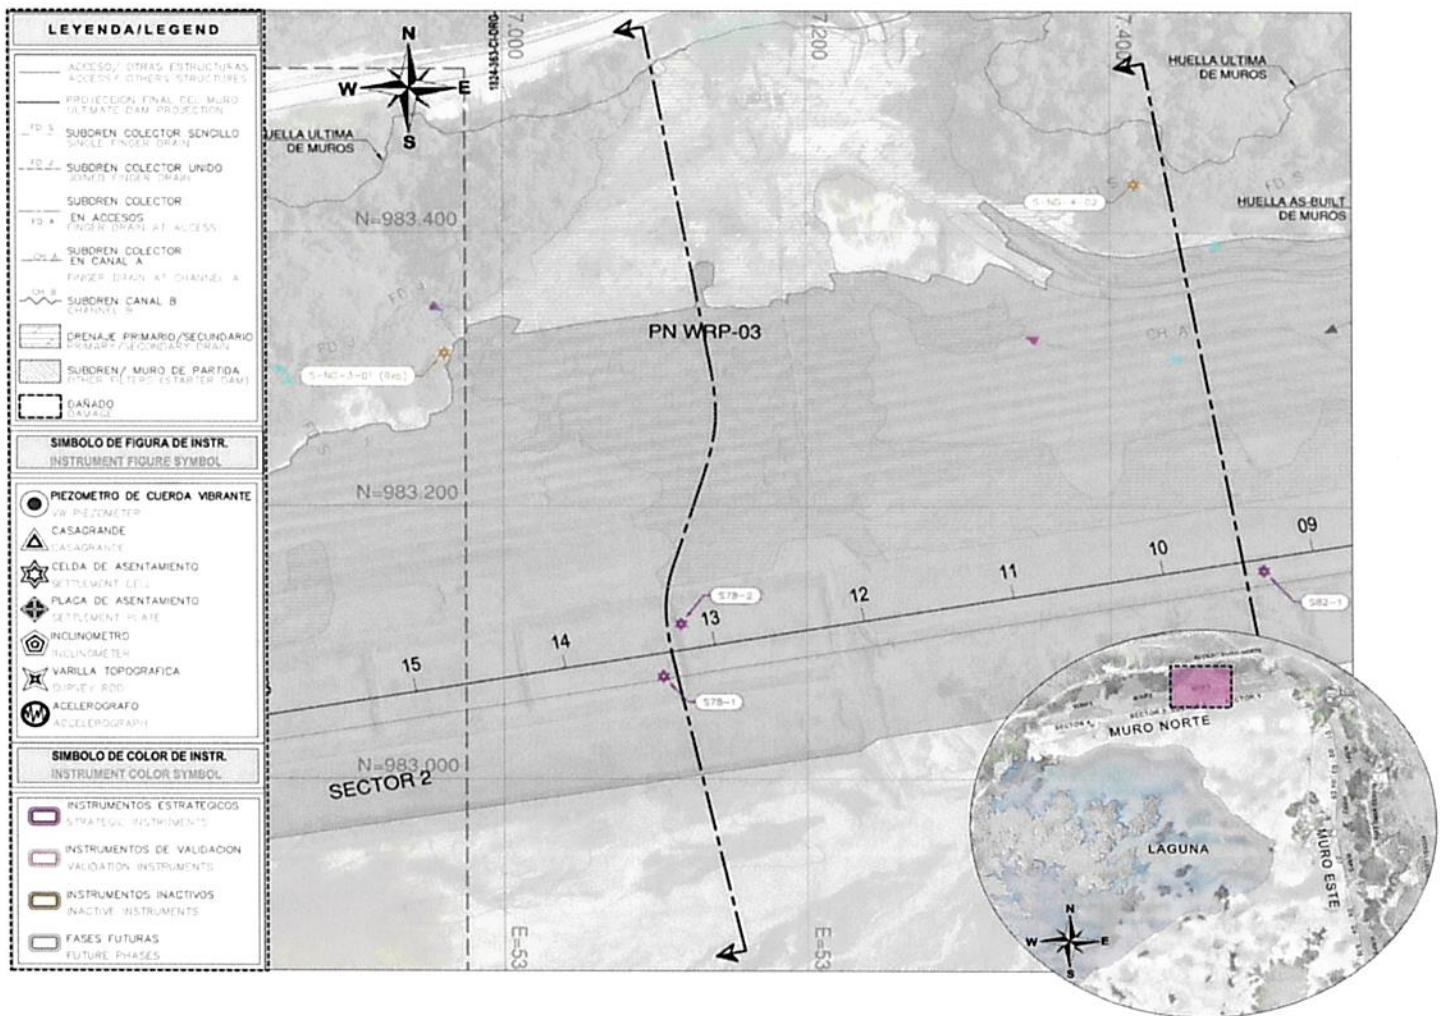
Vista de Planta en el Sector 1 - WRP3 con las Celdas de Asentamiento
